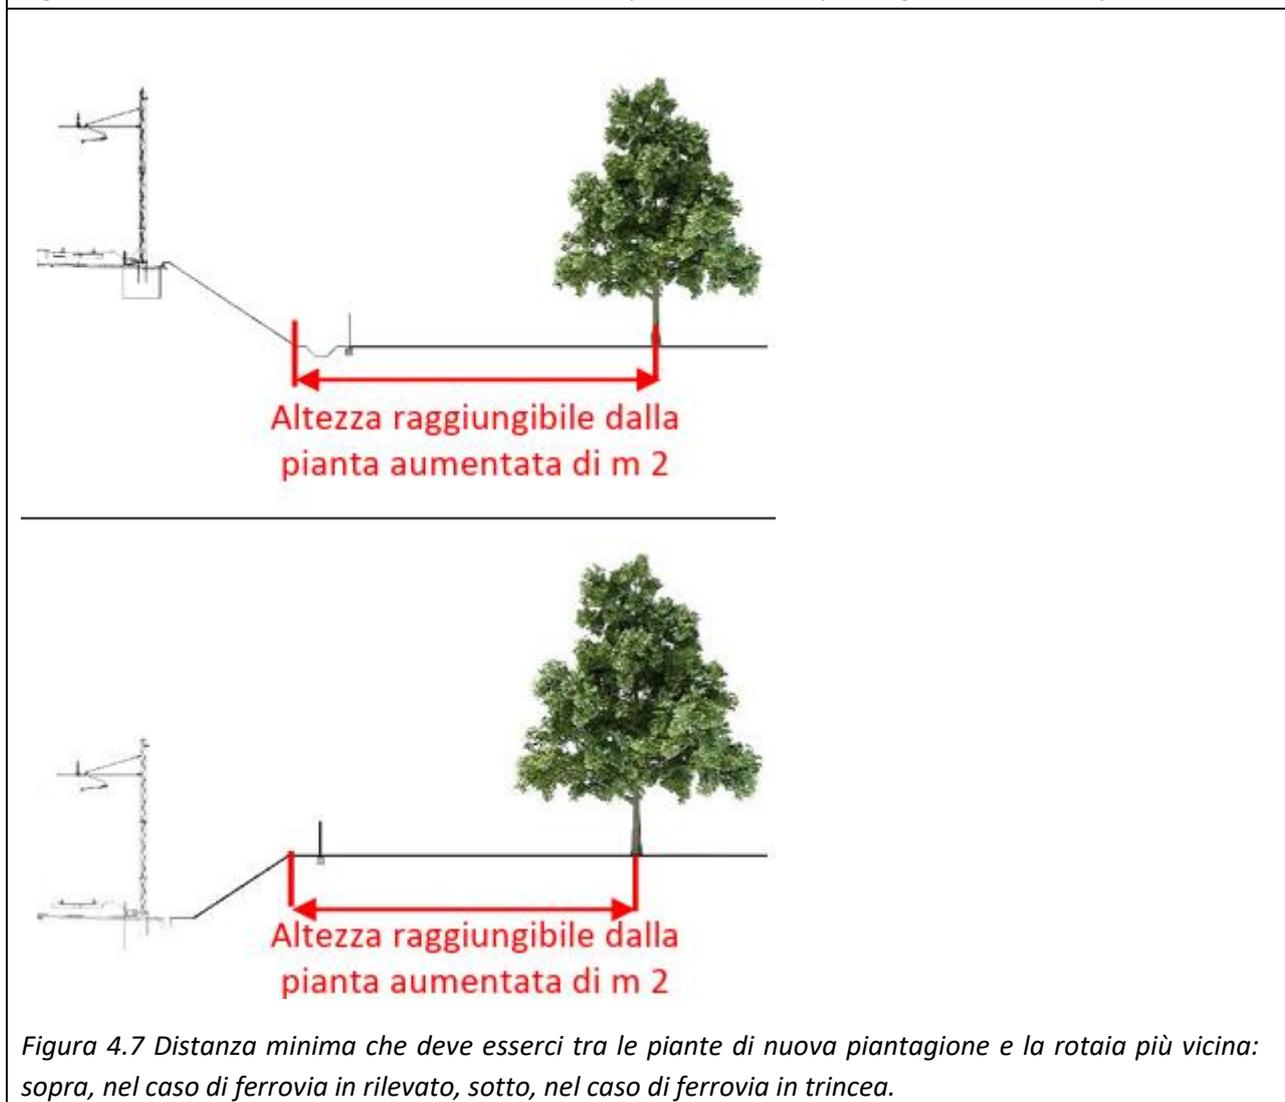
Distanza minima che deve esserci tra le piante di nuova piantagione e la rotaia più vicina: sopra, nel caso di ferrovia in rilevato, sotto, nel caso di ferrovia in trincea.
